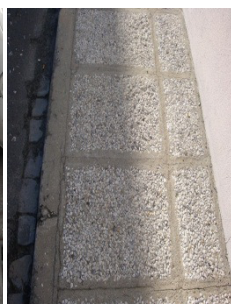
lajetas pré-fabricadas em betão com acabamento em godo lavado - cinza
